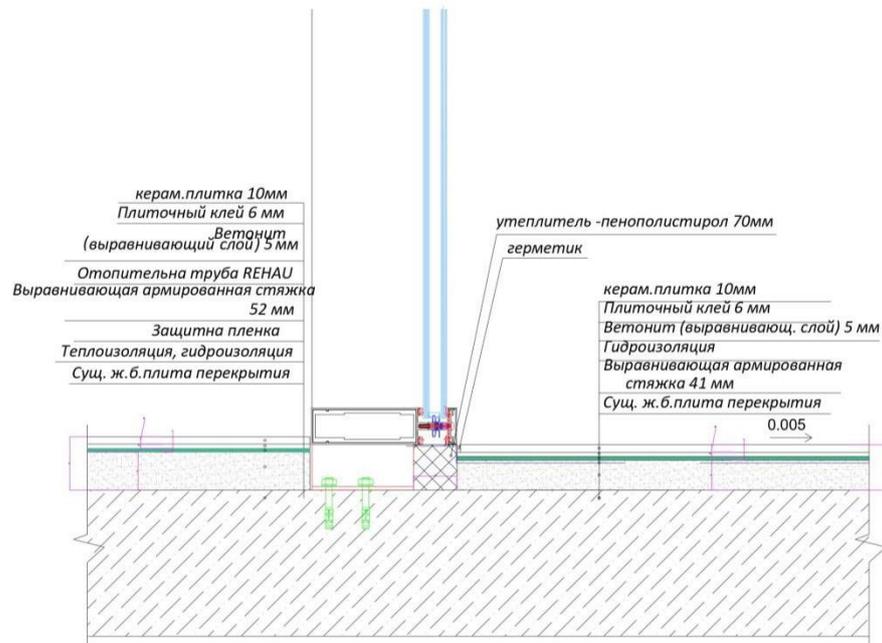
Узел примыкания конструкции витража к суц. колоннам и стенам
